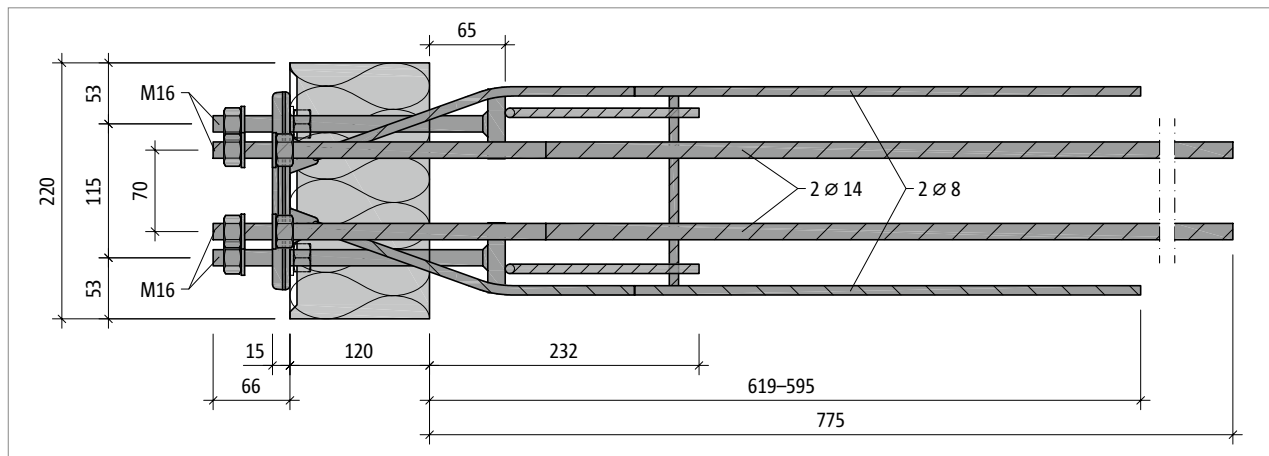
Schöck Isokorb® XT type SK-M1-V1 : vue en plan
